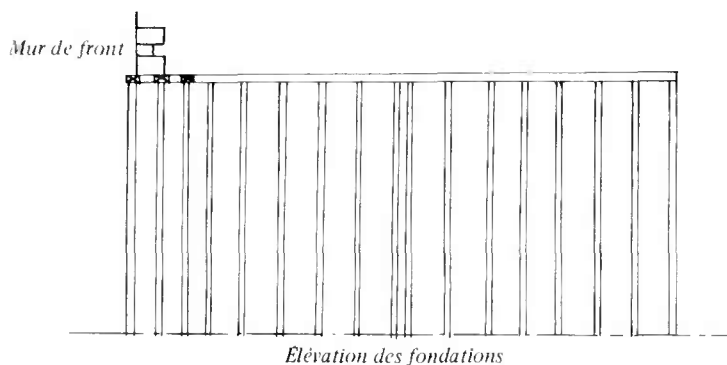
Pont C. Plan du projet des fondations de la culée rive droite.
